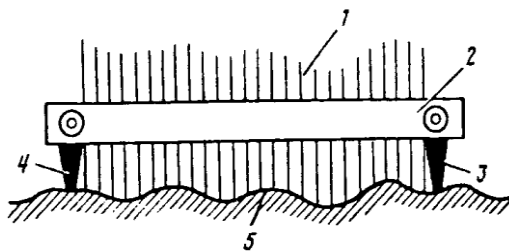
Прибор ПКШ-4: 1 – иглы; 2 – зажимная планка; 3, 4 – опоры; 5 – поверхность покрытия.
